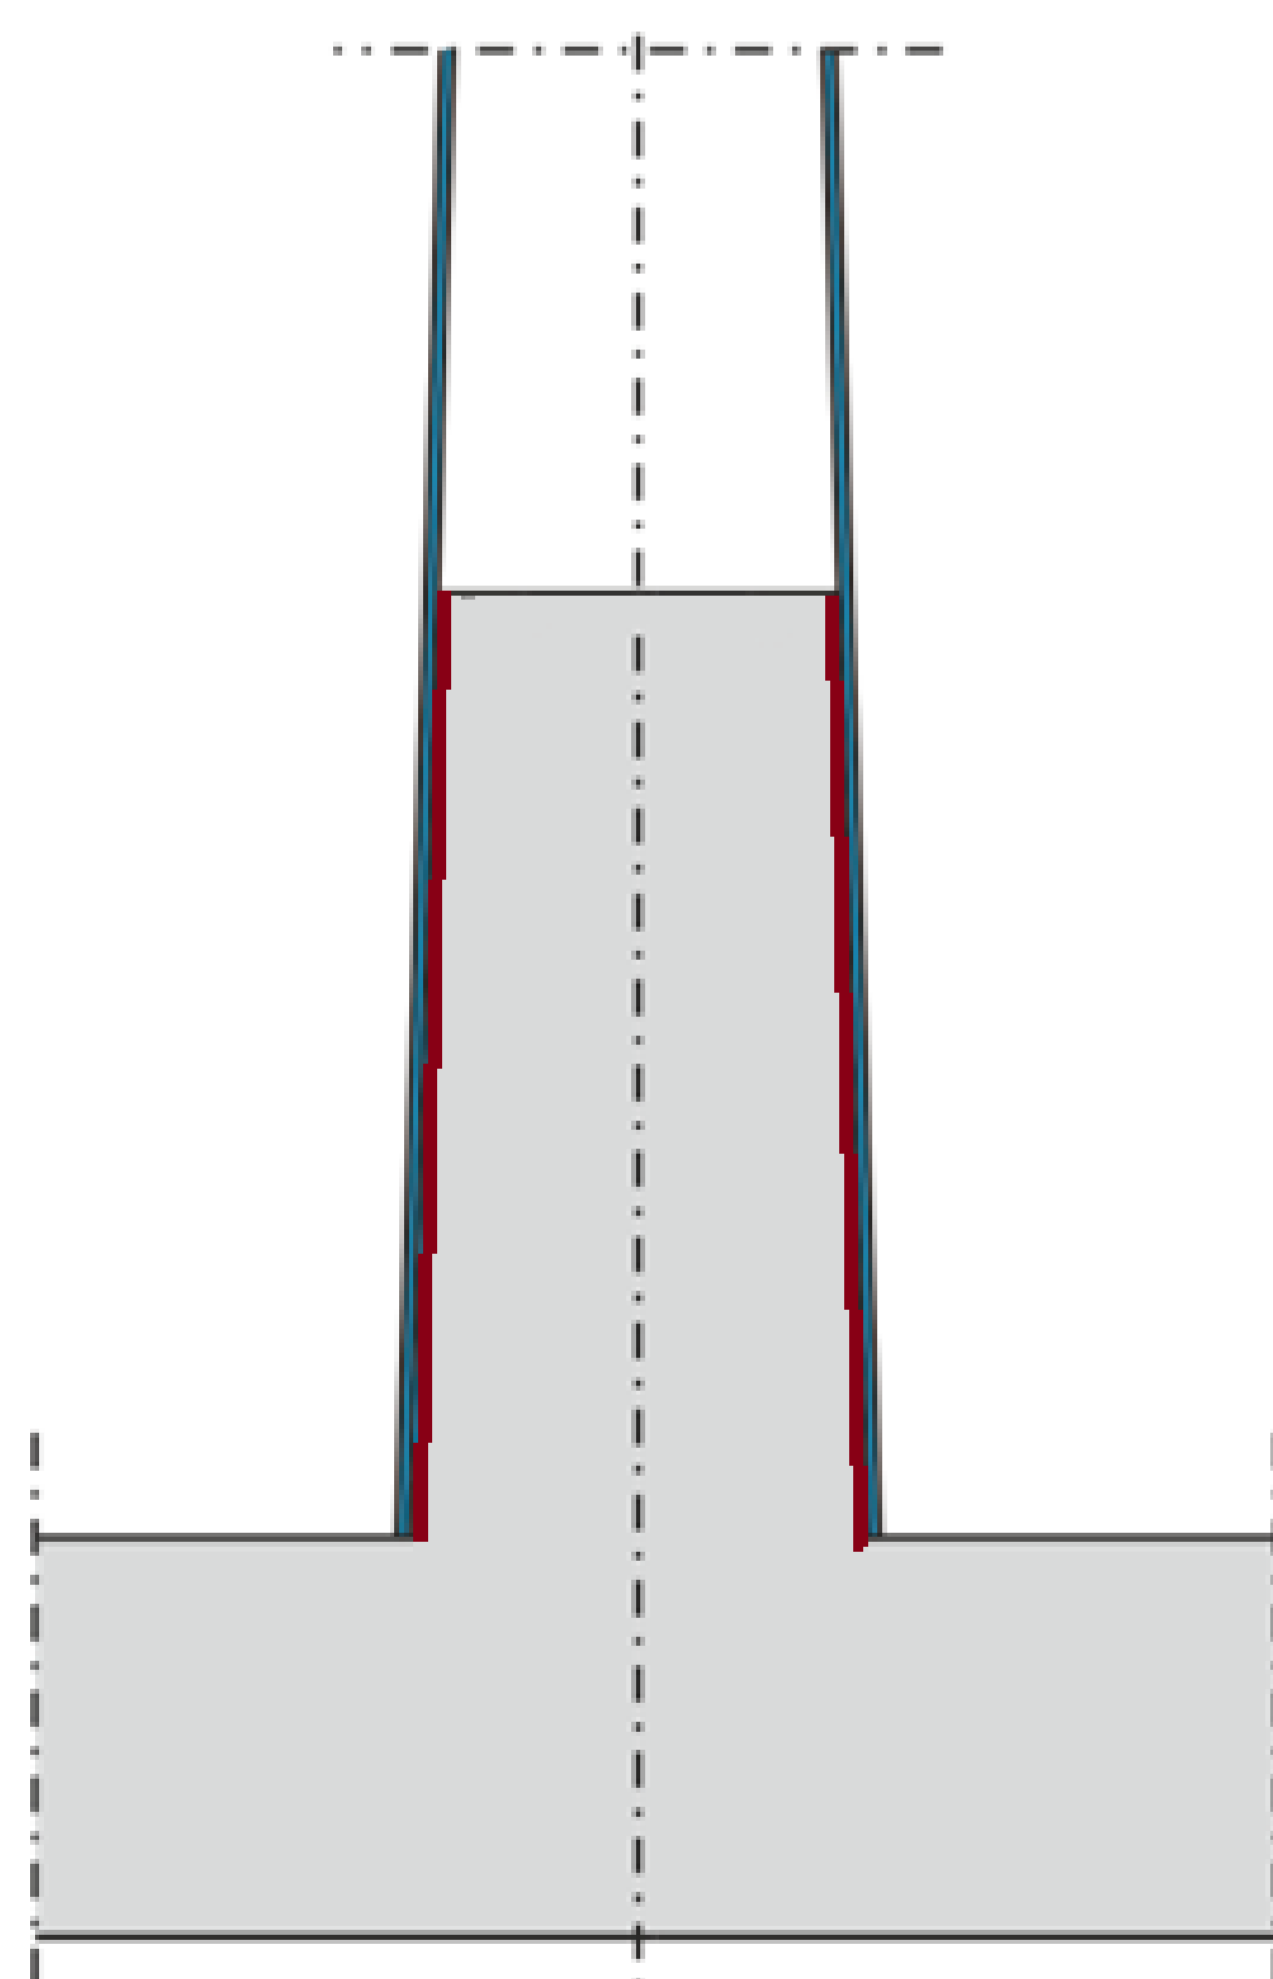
Anbindung eines Stahlmastes an ein Betonfundament als Steckverbindung
